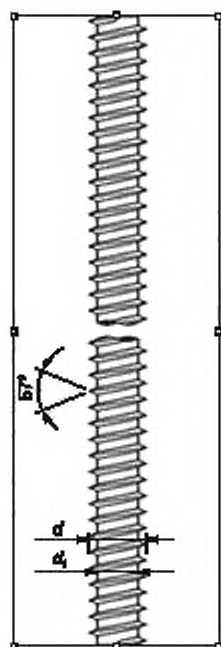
Конструкция винтового стержня с резьбой для армирования древесины
